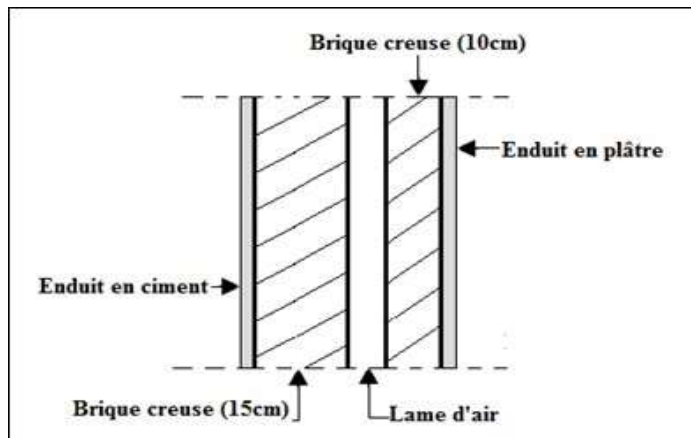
Coupe transversale des murs intérieurs (type 1)
